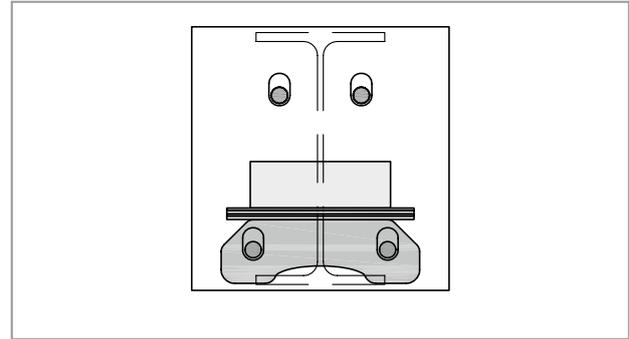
Schöck Isokorb®: Conexión Acero – Hormigón armado; los espaciadores sobre la placa de absorción de carga incrementan la posición de la viga de acero hasta en 20 mm
